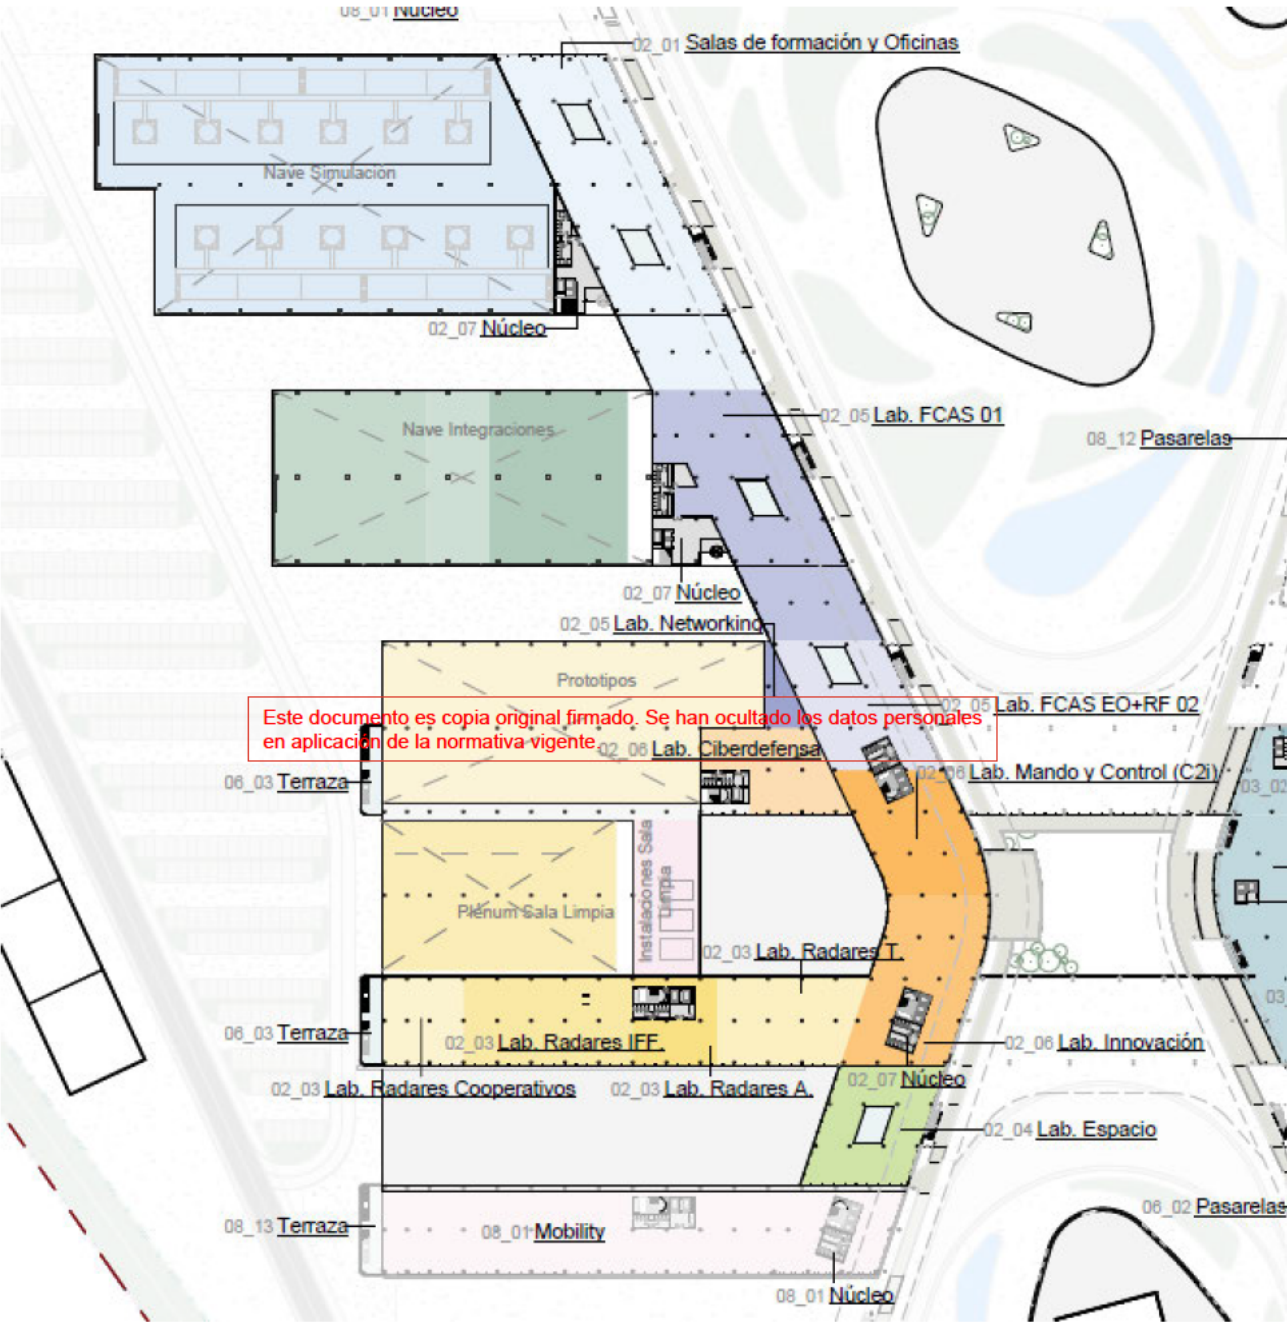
actividades de los edificios D1 y D2 en planta primera. Fuente: Ortiz León.
